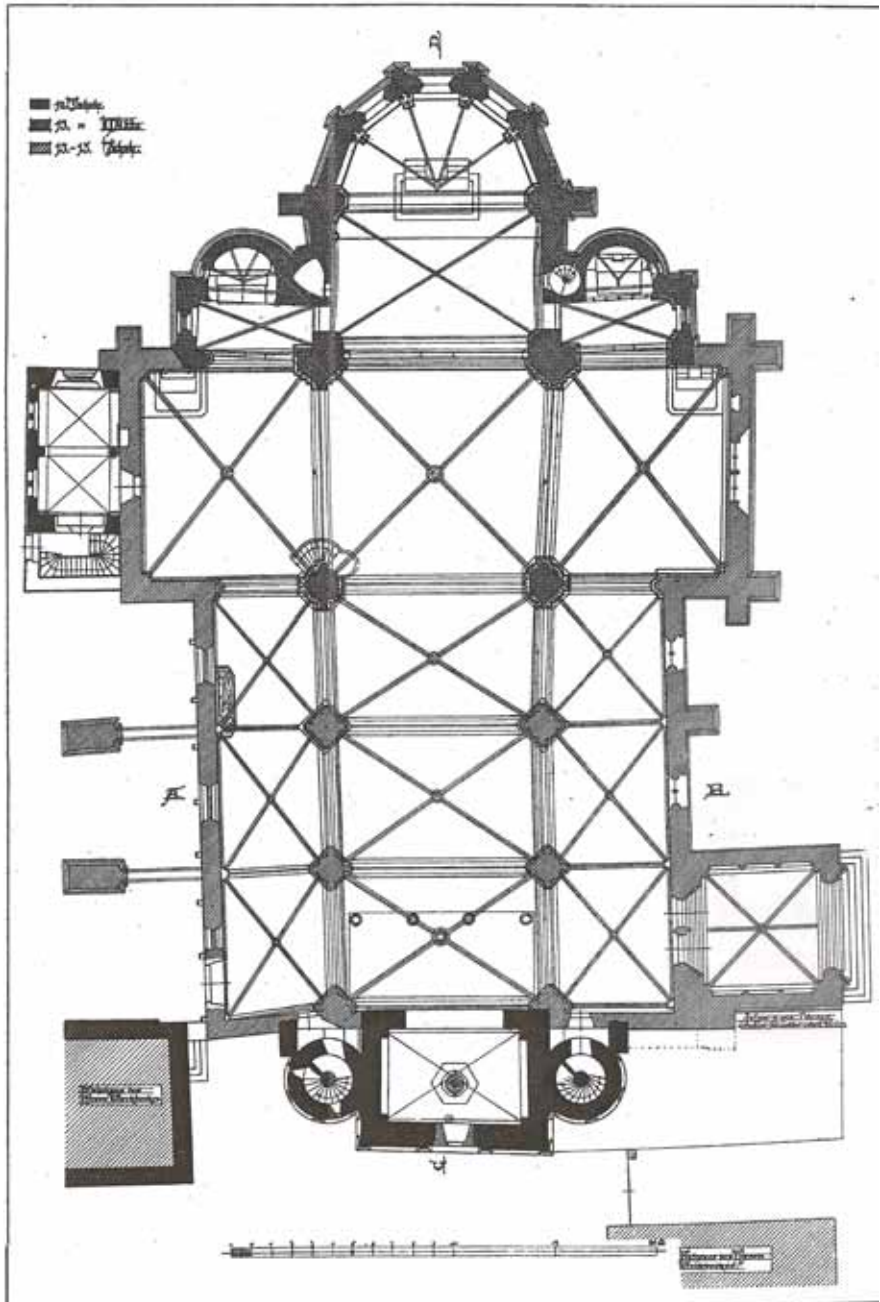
Grundriss der ehemaligen Stiftskirche,
